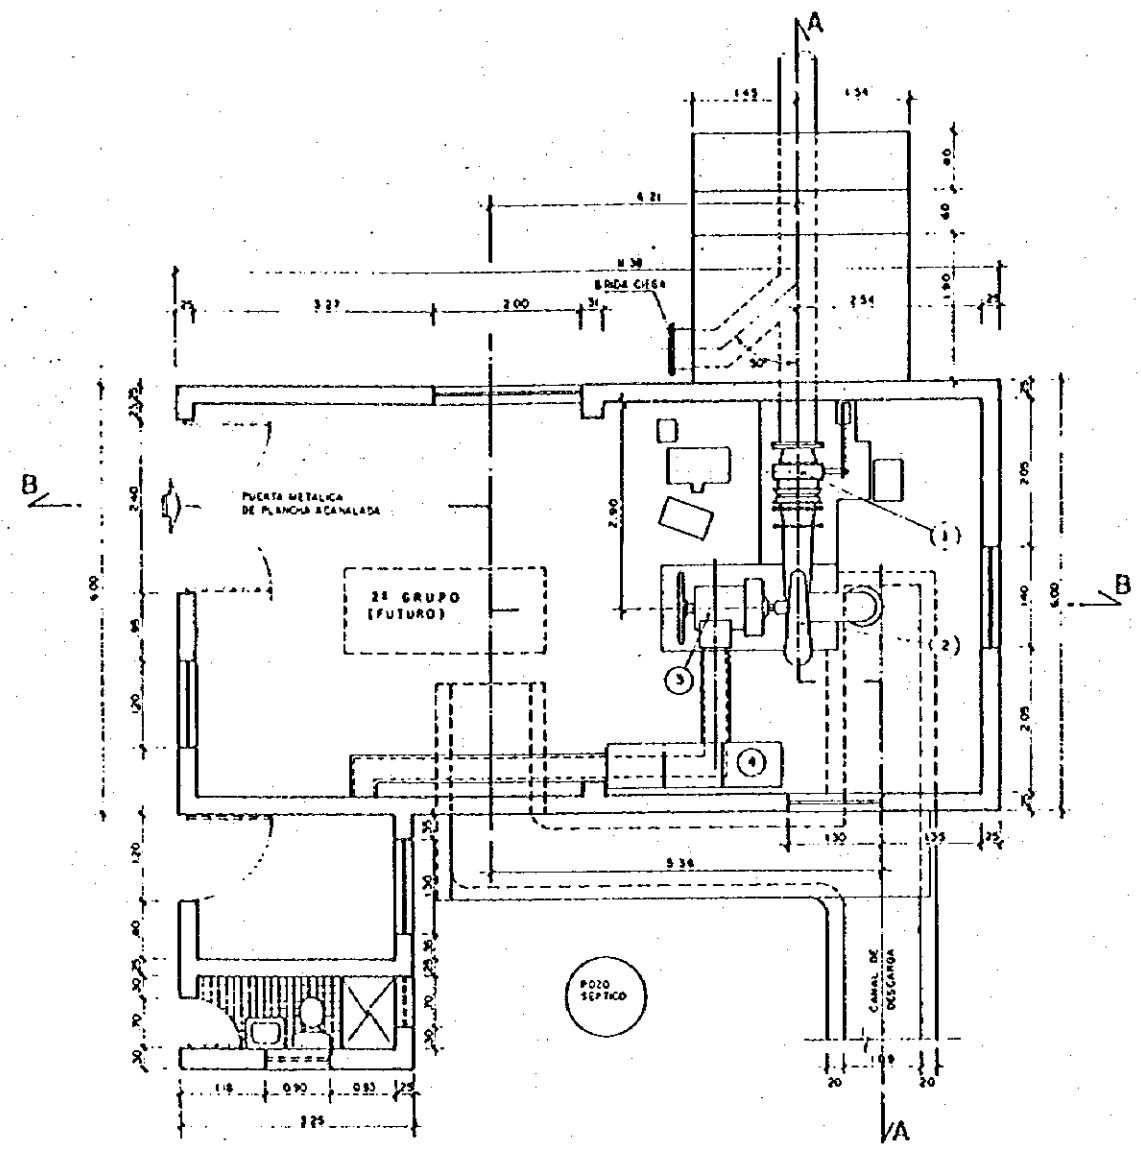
Tubería Forzada-Planta Perfil
